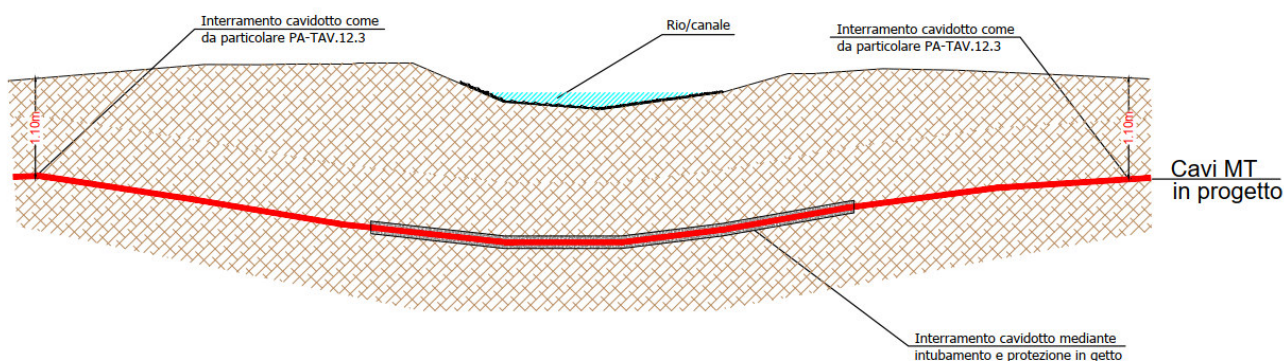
Sezioni tipo di posa cavidotto, tipologico attraversamento rio/canale (da tav. PA-Tav.12.4)
